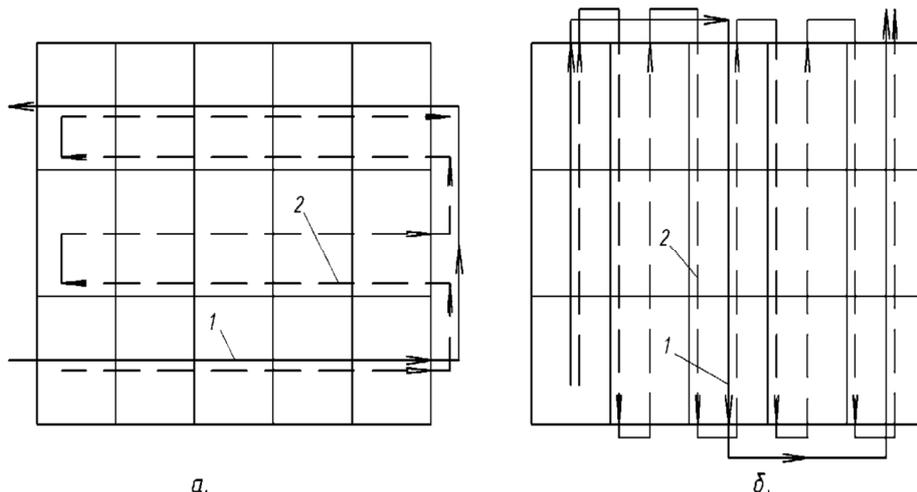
Схемы движения кранов при монтаже многопролетных промышленных зданий:
